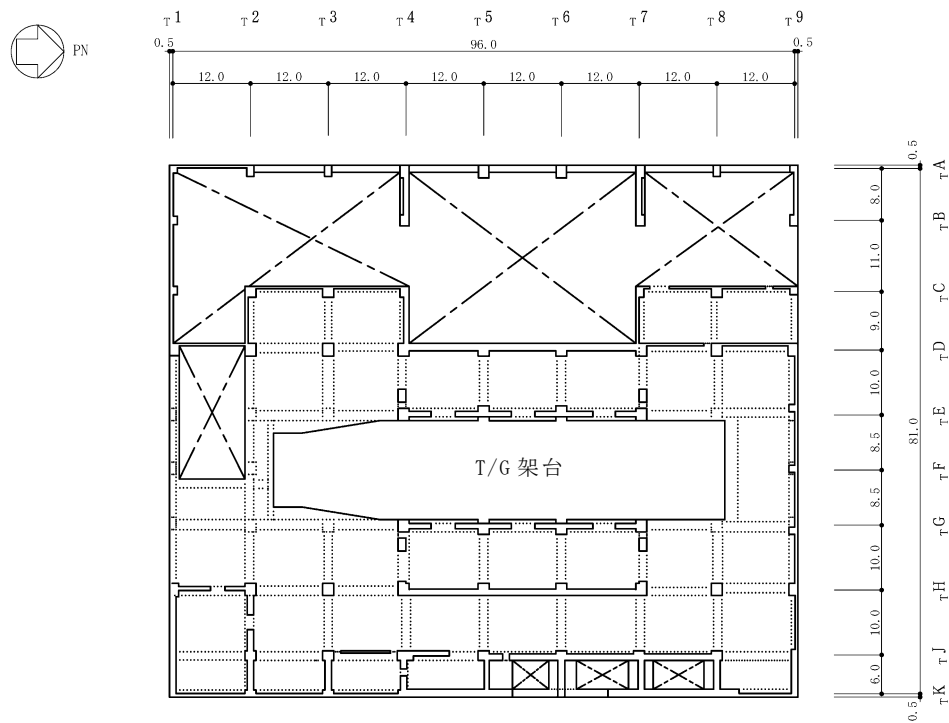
タービン建屋の概略平面図 (2F, T.M.S.L. 20.4m) (4/6) (単位 : m)
